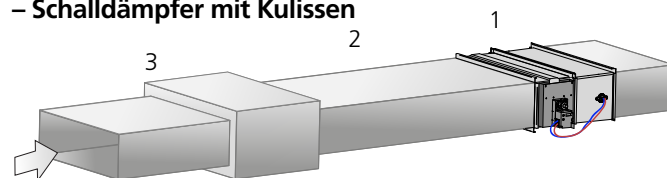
Anströmlänge bei rechteckigen Kanälen und Schalldämpfer mit Kulissen. Die Montage mit gerader Strecke gilt sowohl für Zu- als auch für Abluft.
